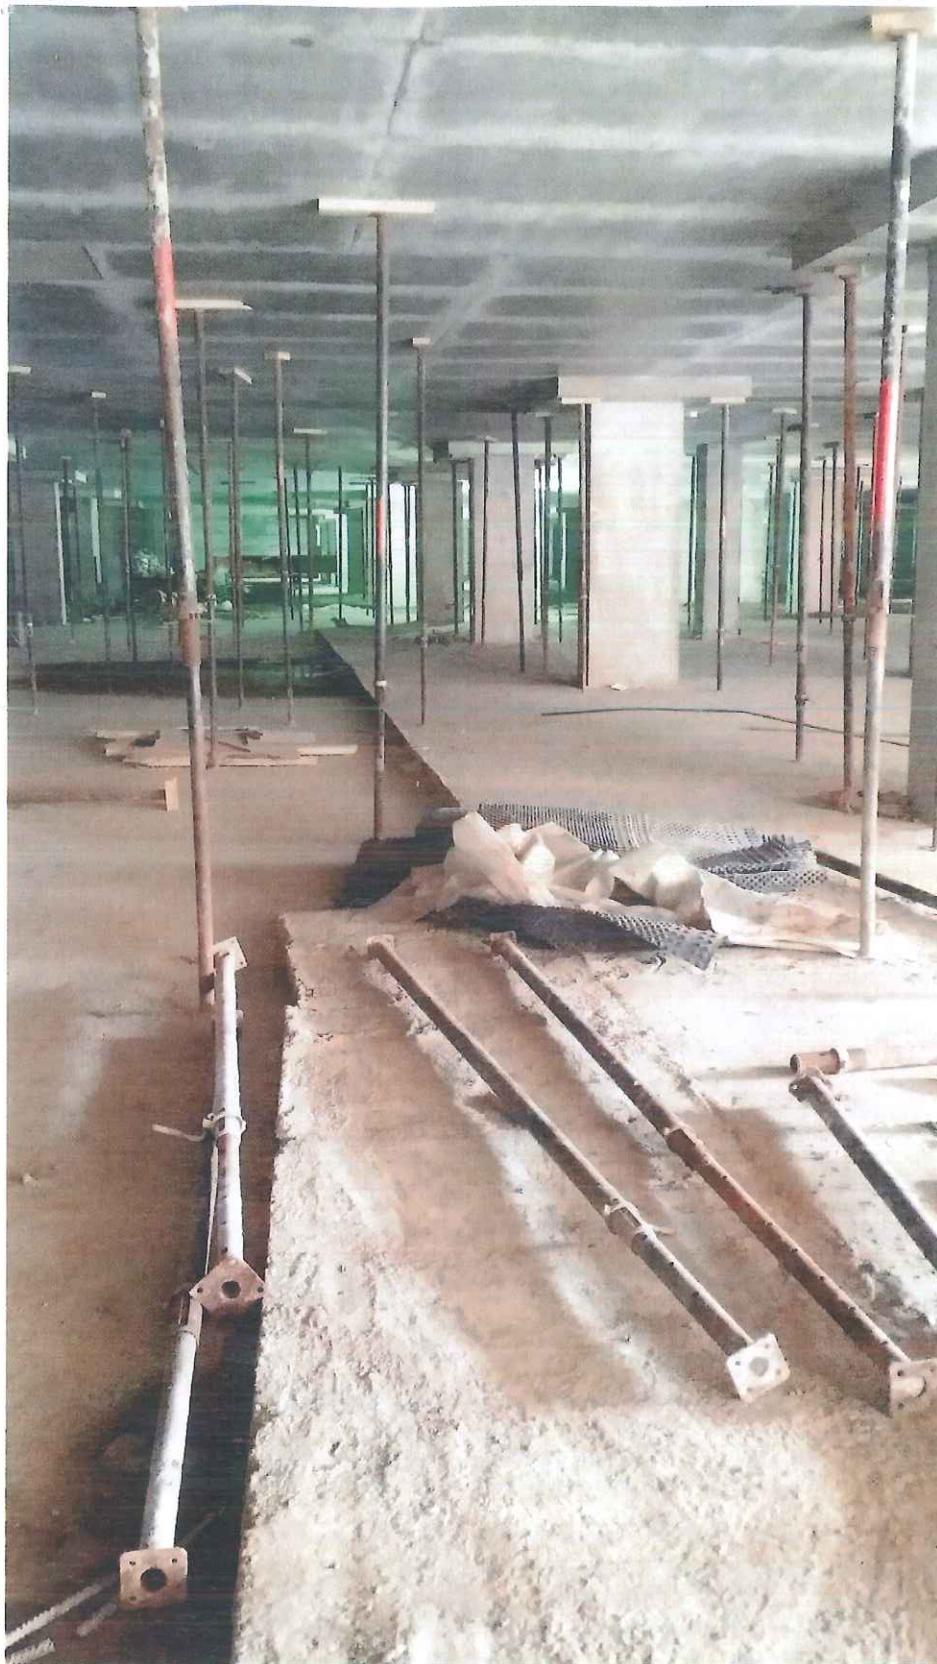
Непонятный перепад в фундаментной плите. По проекту, плита без перепадов.
